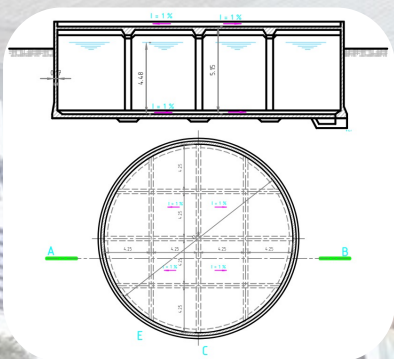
Estanque semi-enterrado de concreto armado 1000 m³.
